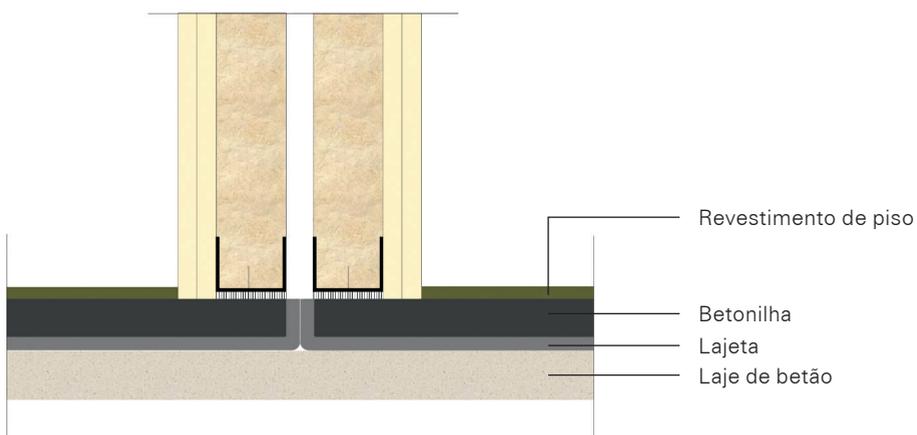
Compartimentação horizontal entre fogos, com laje maciça de betão armado e revestimento de pavimento em ladrilhos vinílicos [ref. 22]
